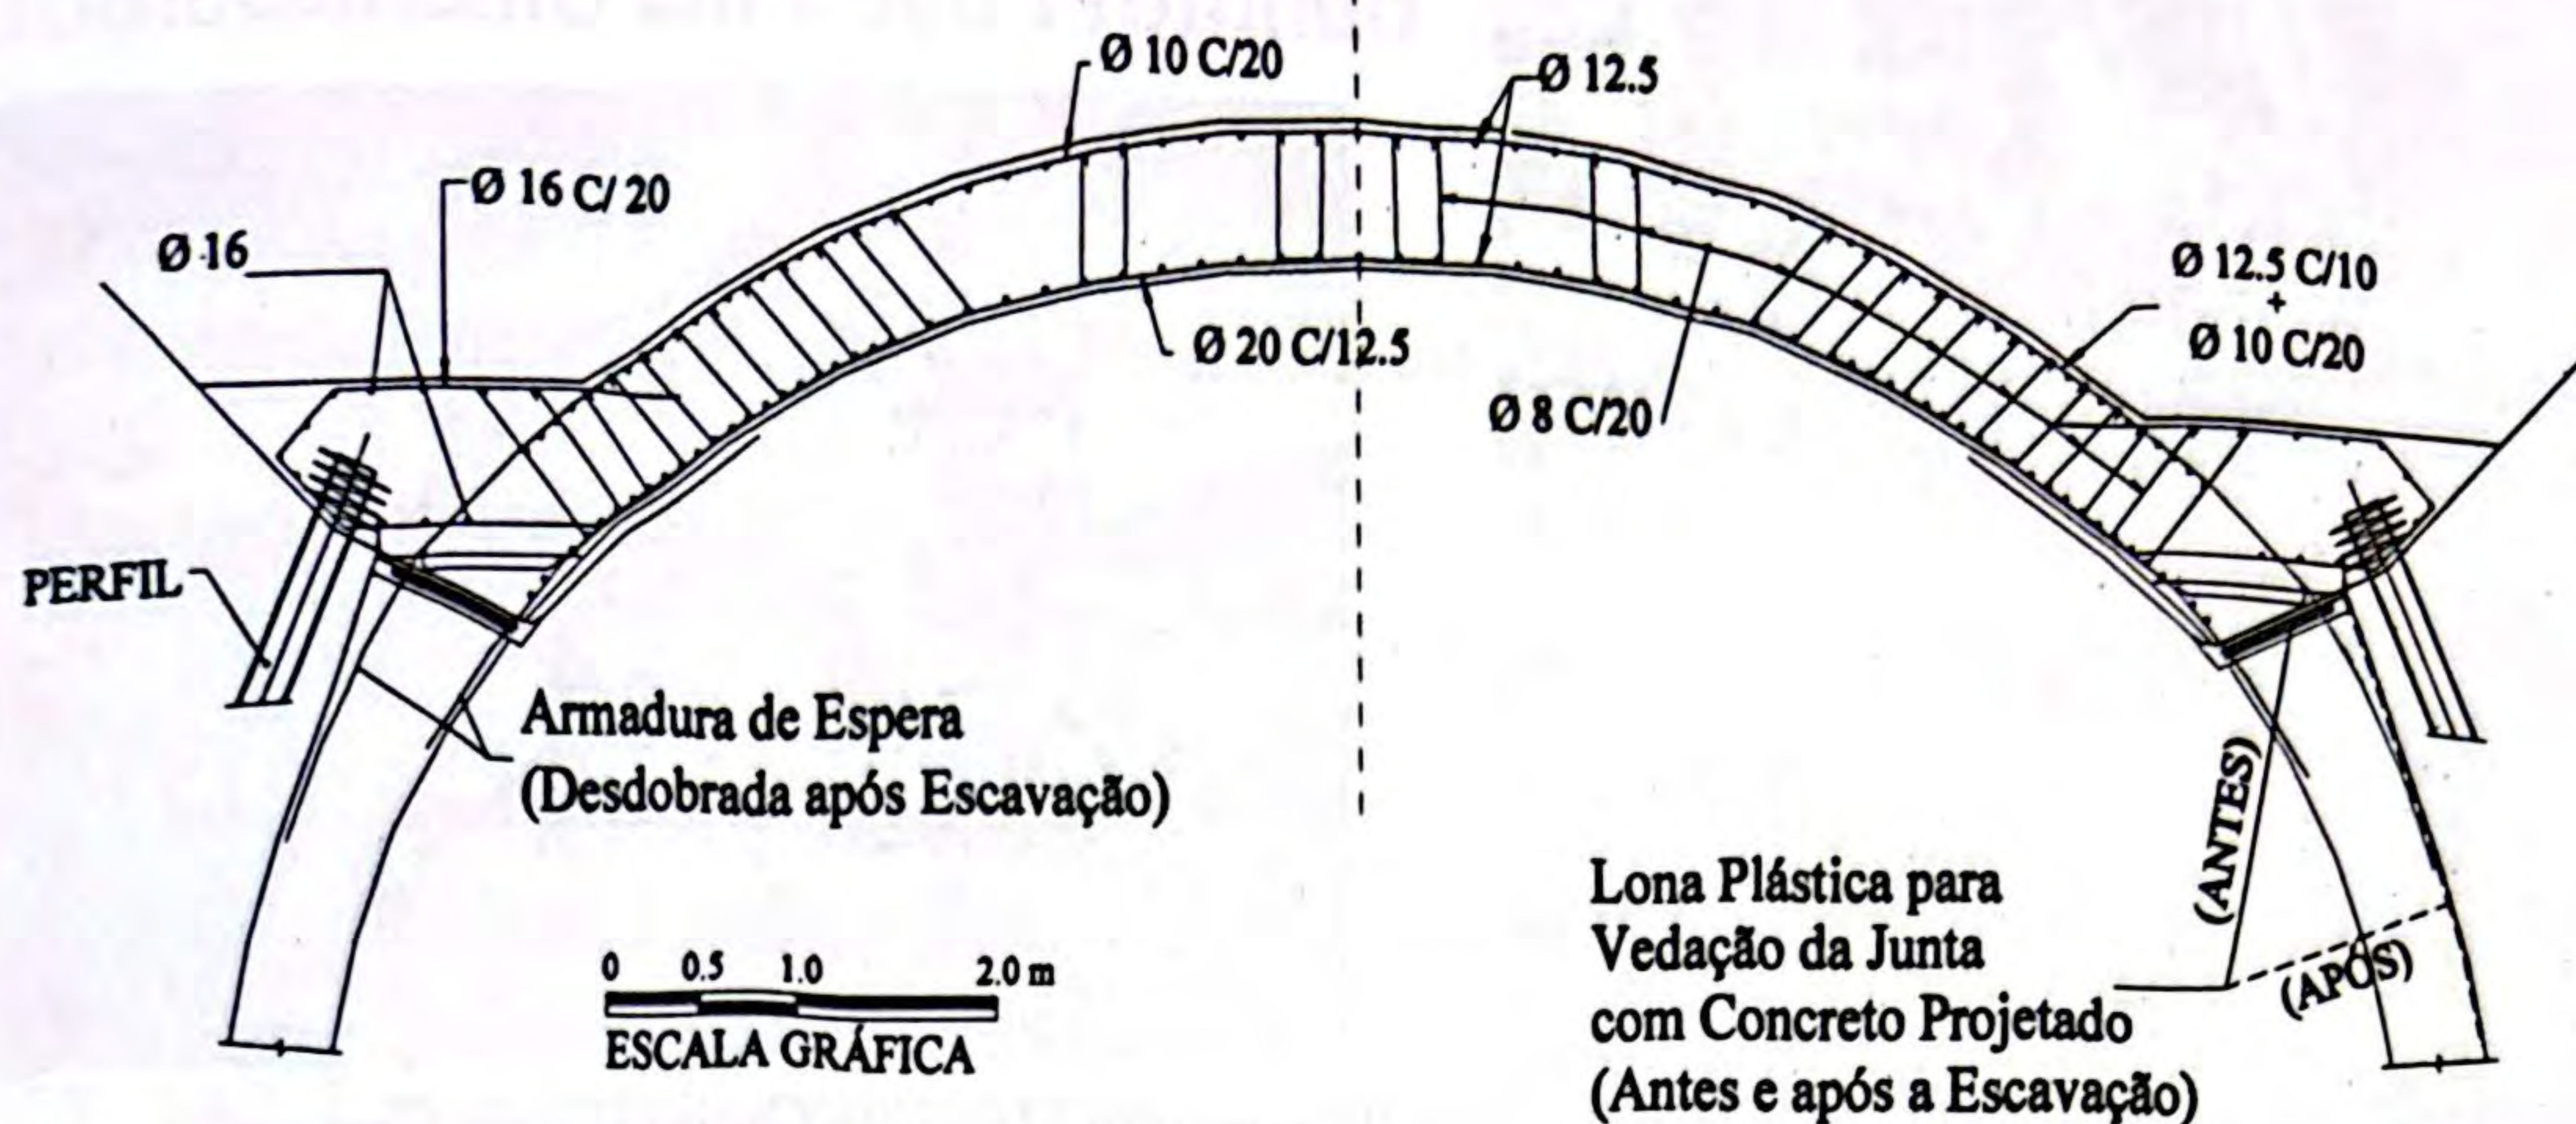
Croquis Indicativo da Armação da Laje de Teto
